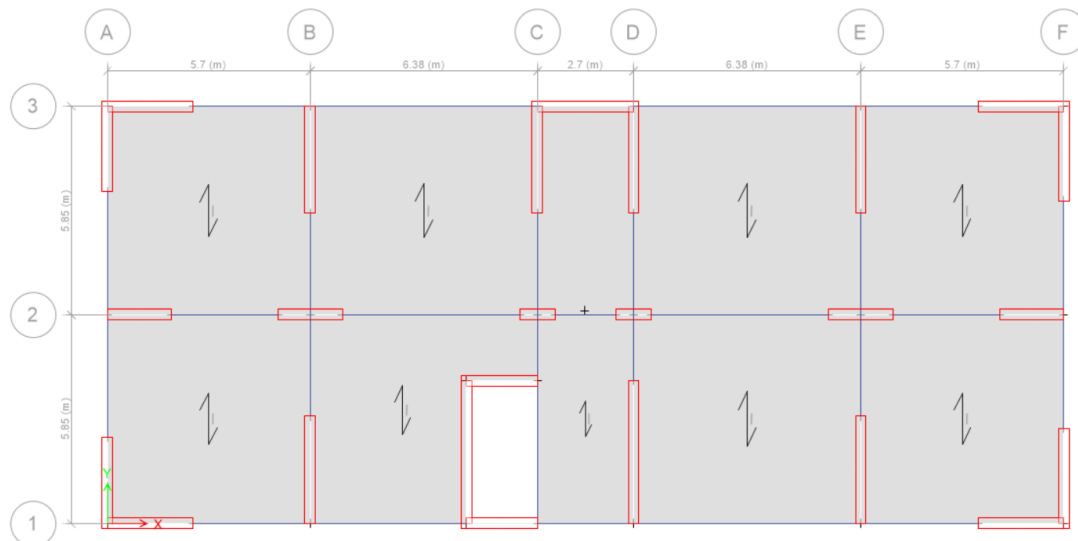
Planta típica definida finalmente para el edificio multifamiliar.
